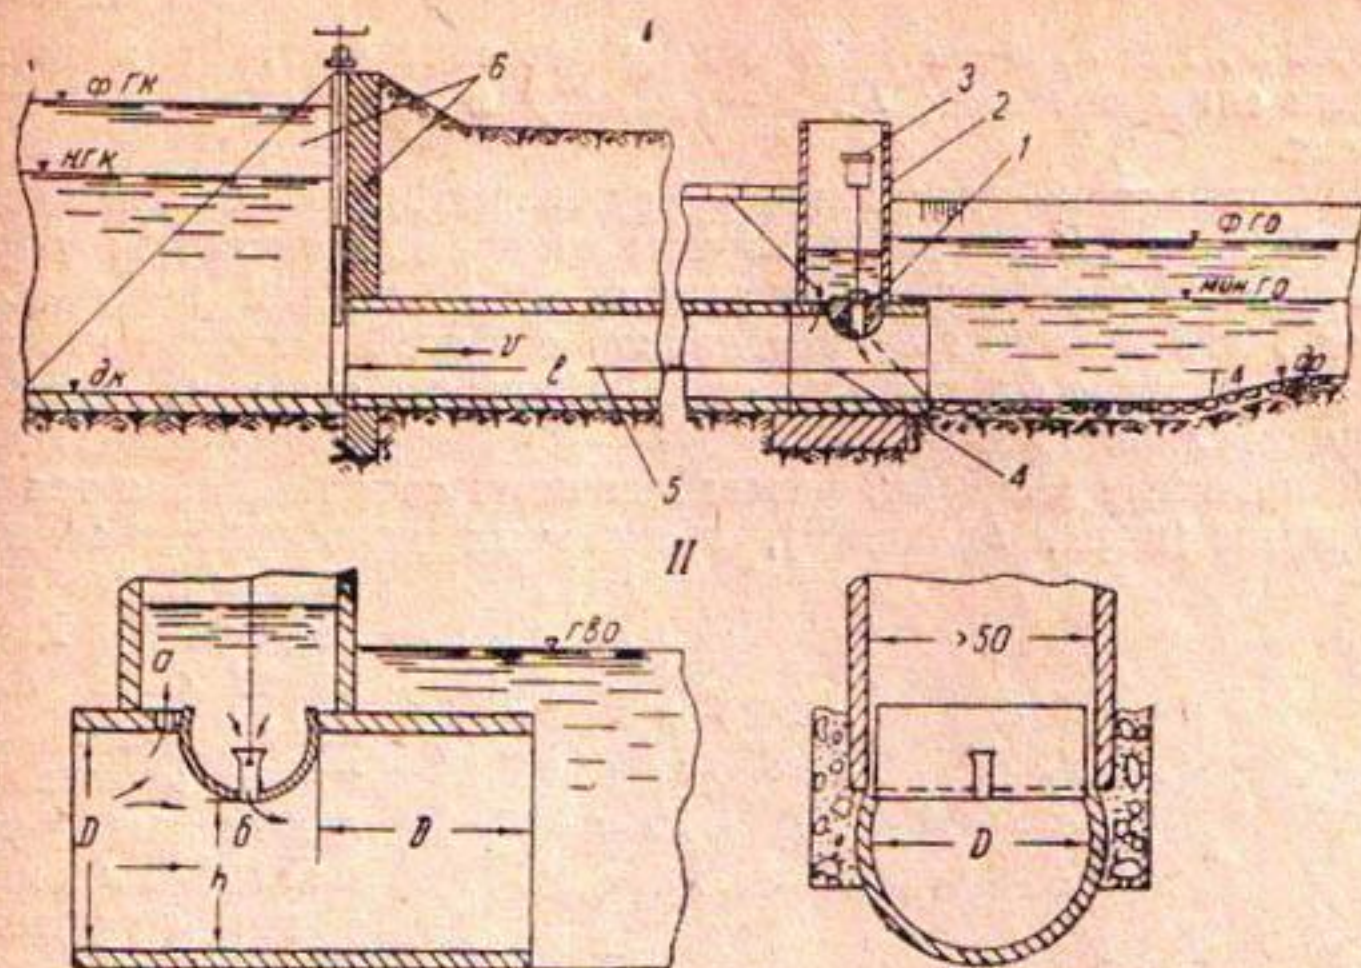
Трубчатый водомер-регулятор с полуцилиндром: I — продольный разрез по оси сооружения; II — деталь водомерного устройства.
